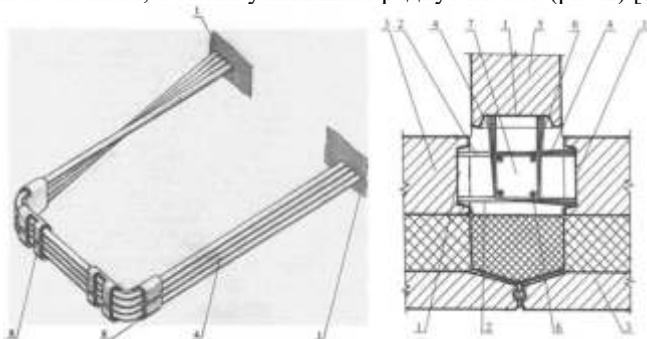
Вертикальный стык панелей с гибкими связями без сварки
